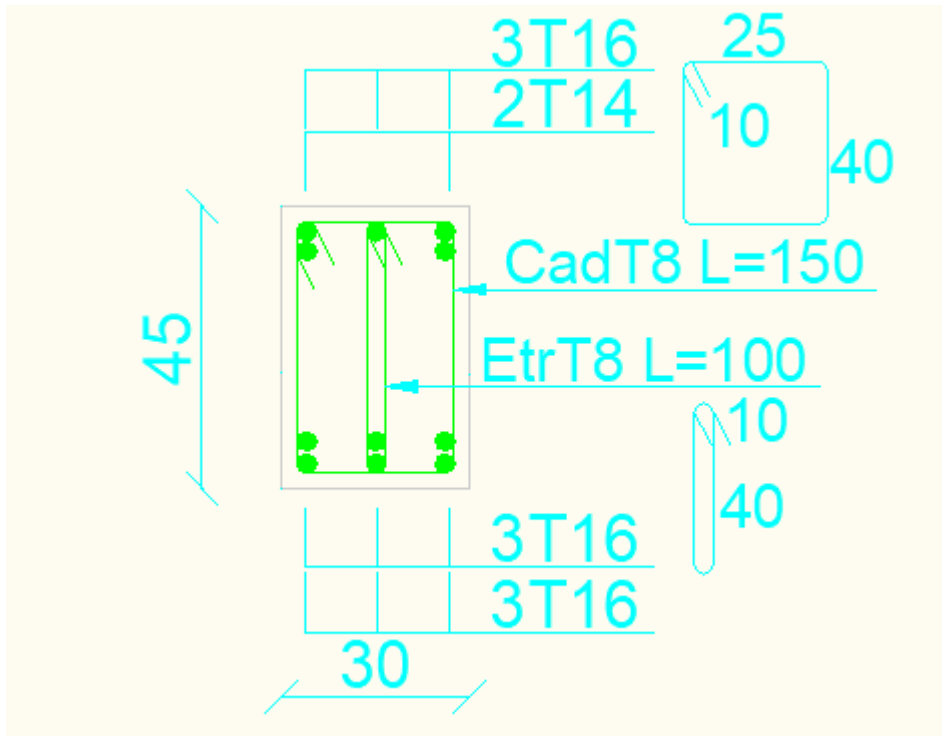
Schéma de ferrailage poutre principale Niv 8 sur appuis.
